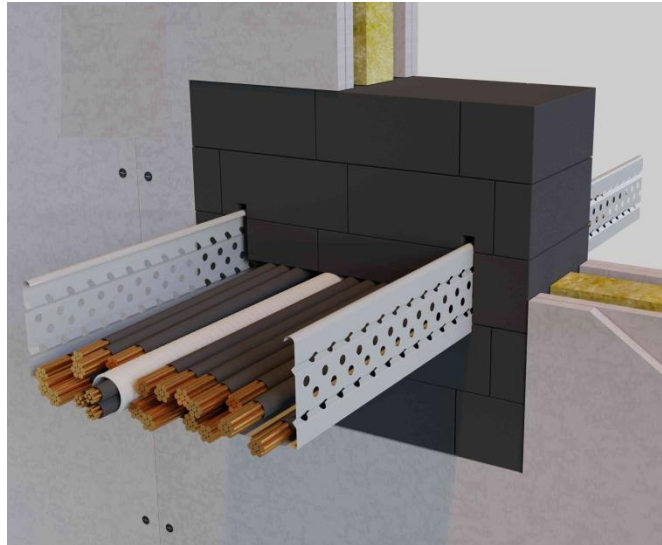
Модель монтажа проходок на основе пеноблоков DT (AF Brick)
